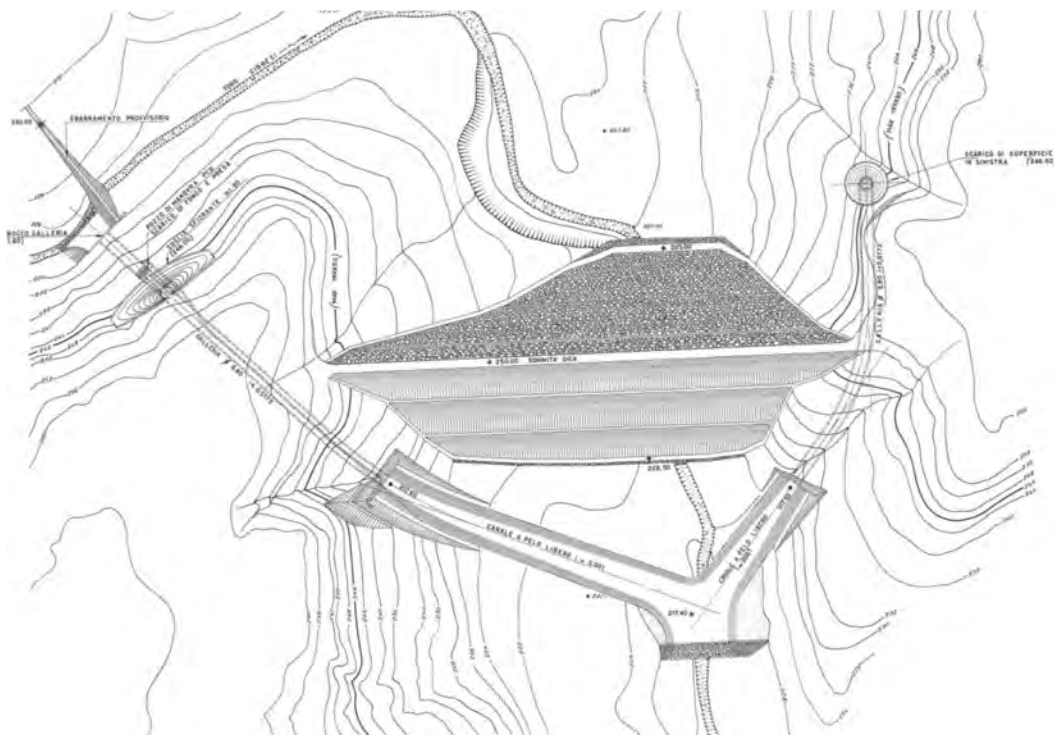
Progetto di massima 1969 – Planimetria della diga e delle opere annesse
